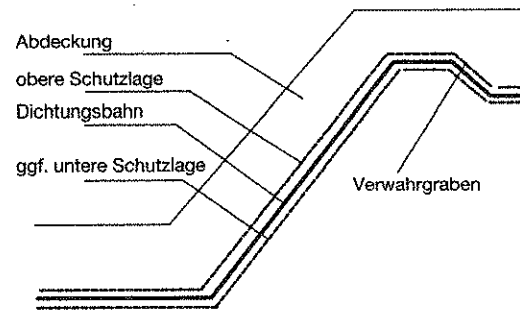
Abdichtung von Wasserbecken (z.B. Rückhaltebecken)
